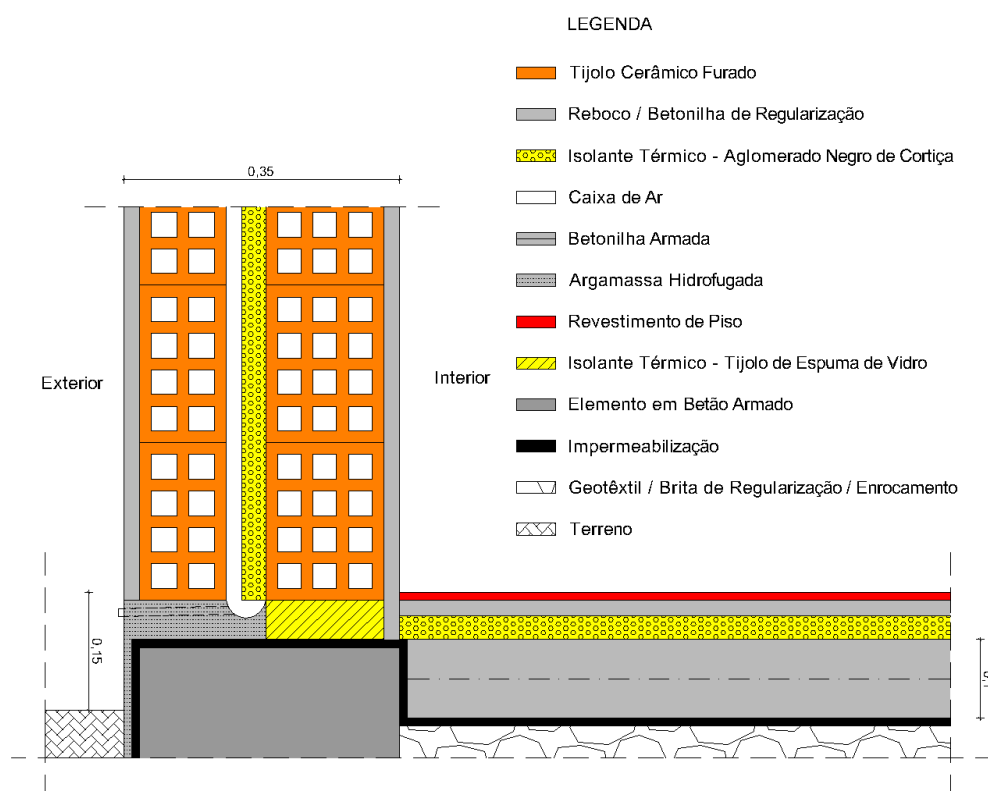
Ligação da fachada com pavimento térreo, adaptado de [10]
